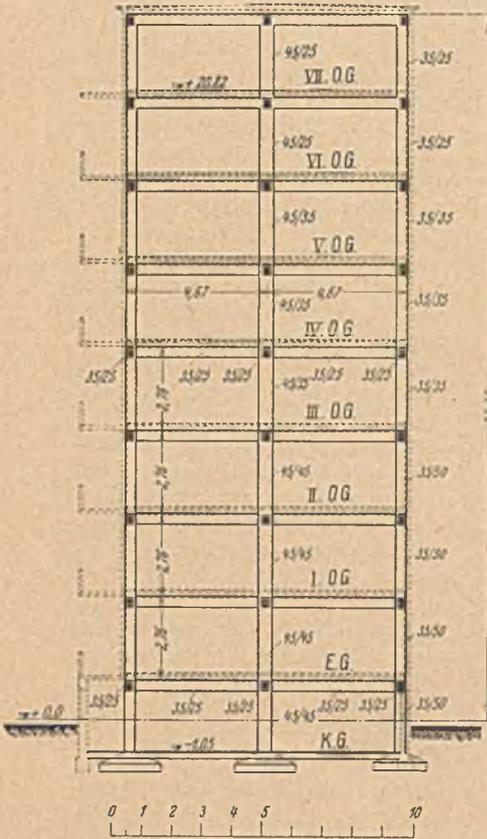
Querschnitt durch das Eisenbetonskelett.
